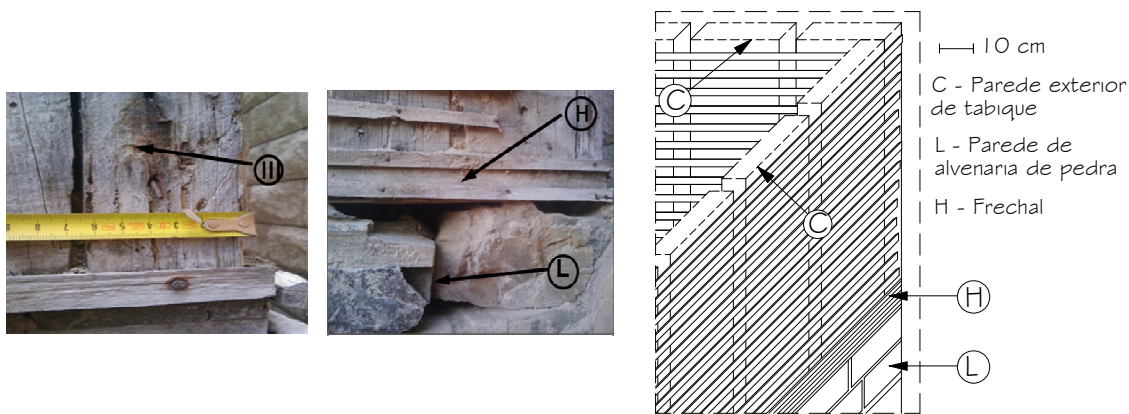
Ligação de tábuas ao frechal e conexão de canto de paredes exteriores
